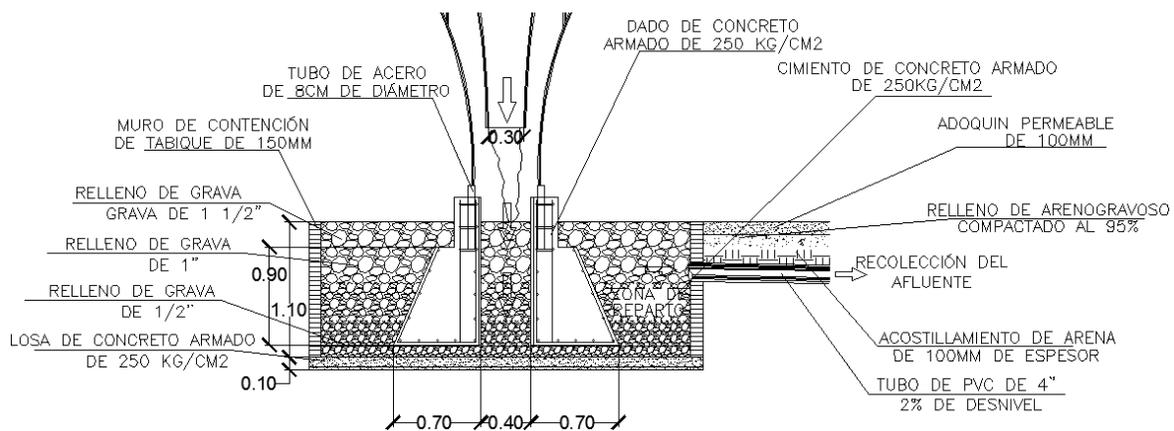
Sistema de tratamiento de aguas pluviales
